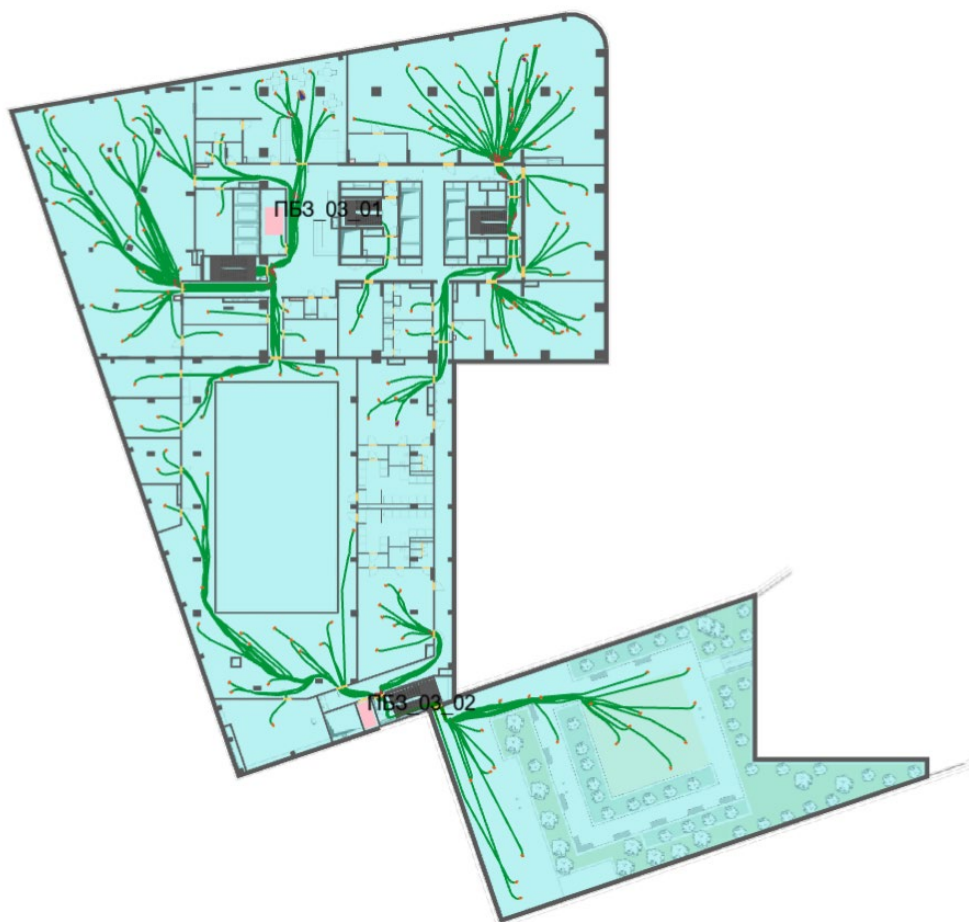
План 3-го этажа и нанесенная на него расчетная (принципиальная) схема эвакуации
